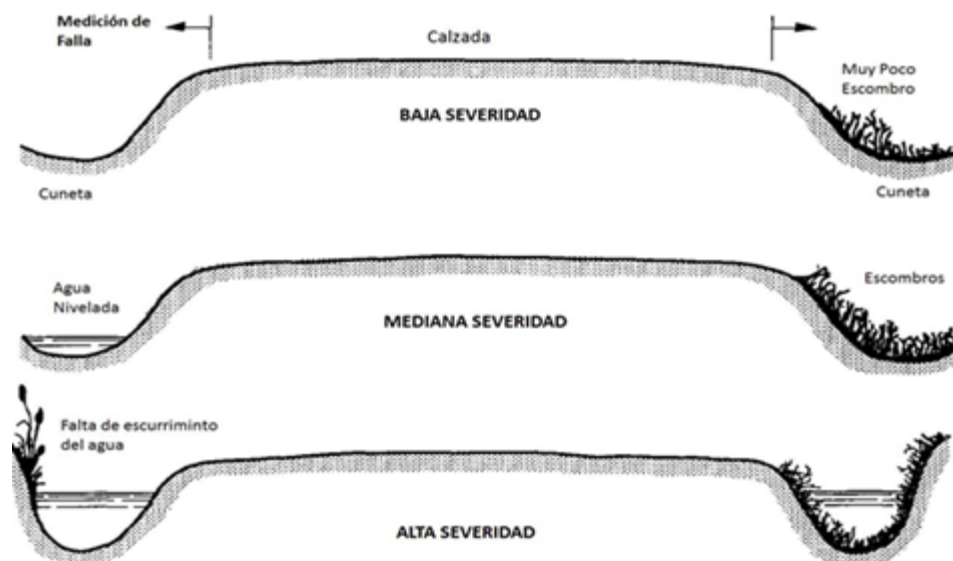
Drenajes Inadecuados en los Bordes de la Carretera.
